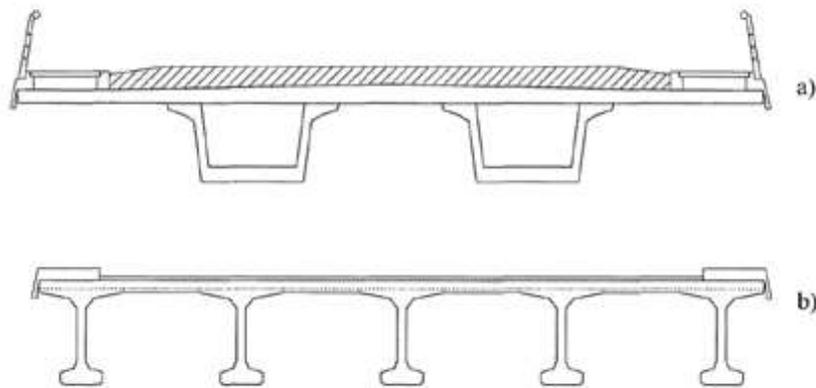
Tipos de vigas prefabricadas. Fuente: Manterola, Javier “Puentes I”[58]
